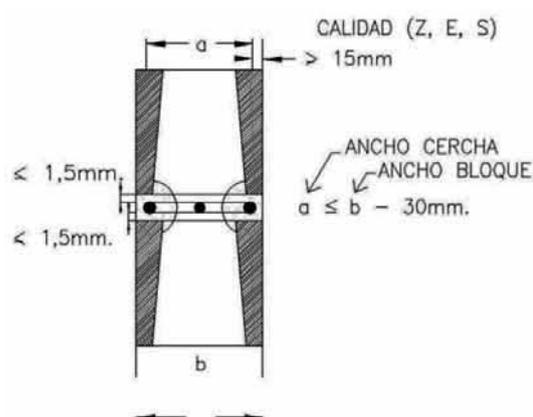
Disposición de la armadura prefabricada de tendel con los recubrimientos mínimos de mortero.
